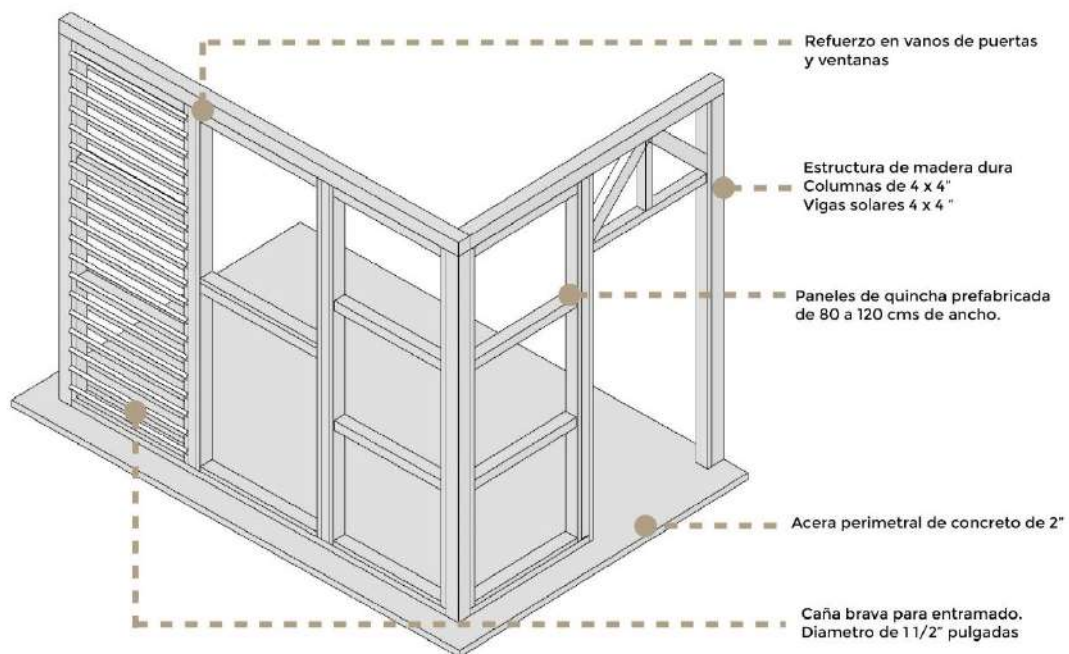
Propuesta para estructura para quincha prefabricada. [Realizado por autor]
